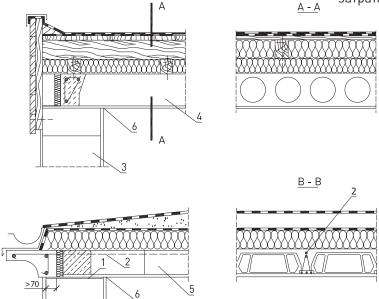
Совмещенное вентилируемое покрытие-кровля
